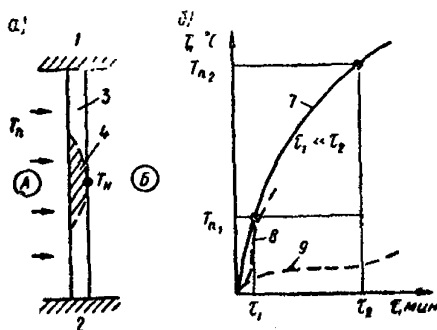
Влияние хрупкого разрушения бетона на предел огнестойкости ограждающей железобетонной конструкции
